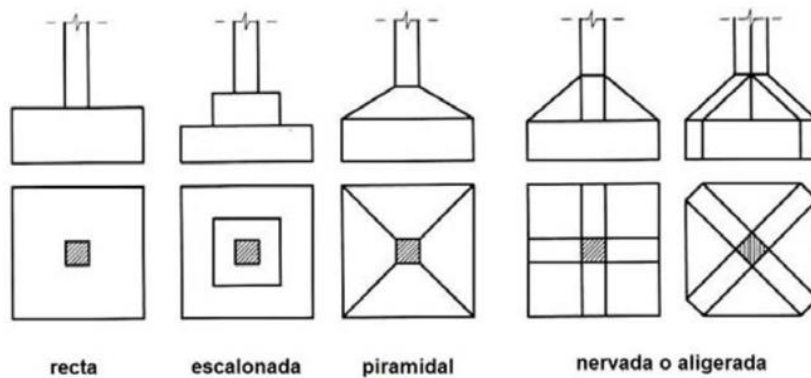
Clases de zapatas aisladas de acuerdo a su forma
